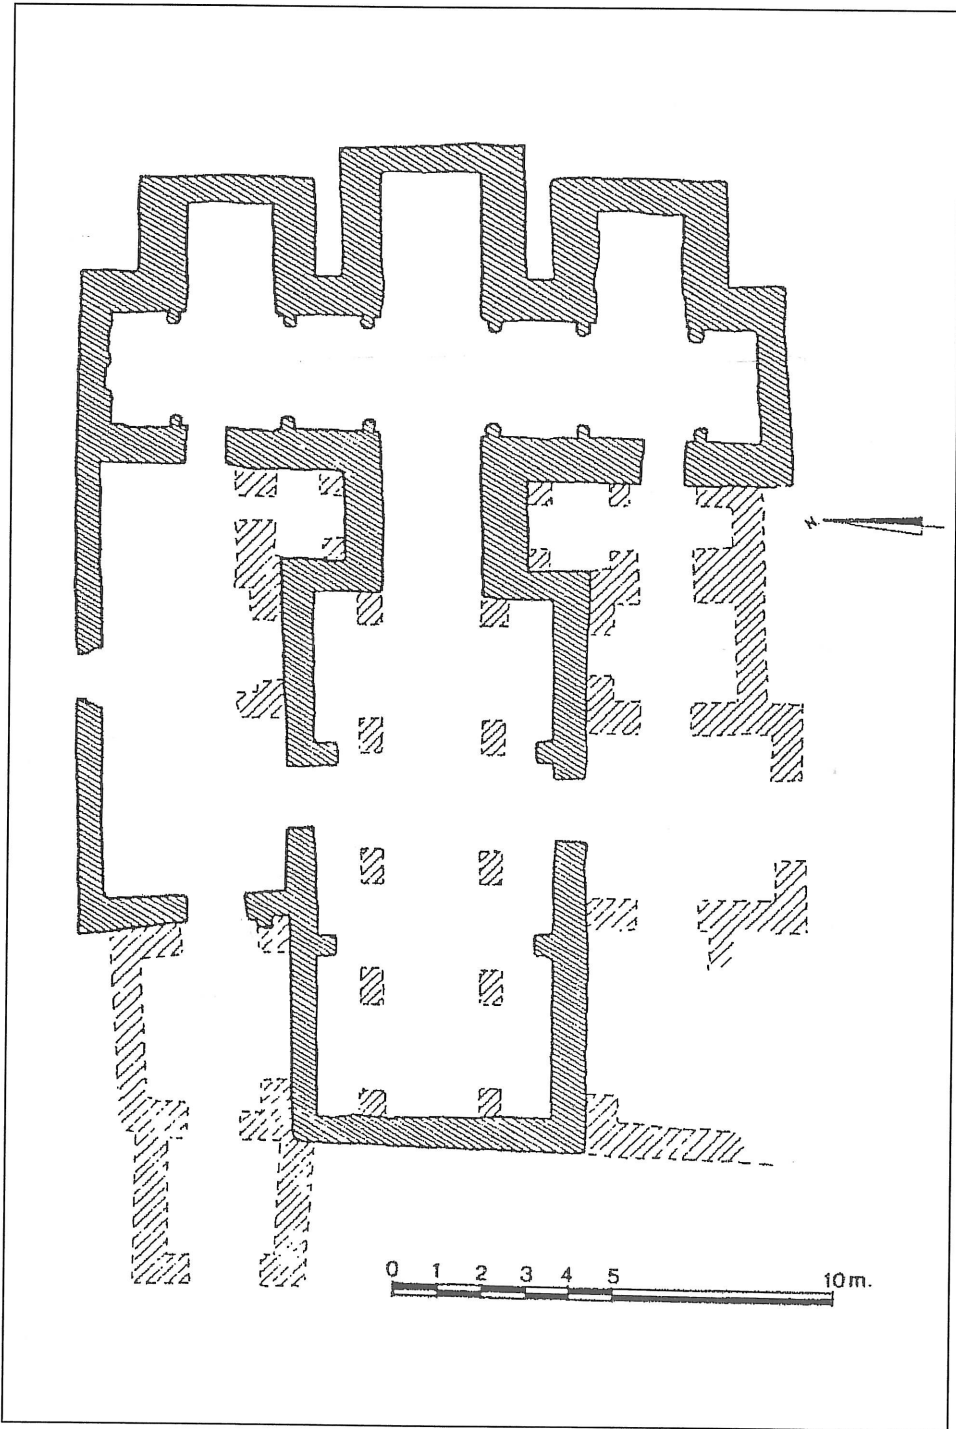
Santa Lucía del Trampal. Alcuéscar (Cáceres). Planta (según: Caballero Zoreda).
